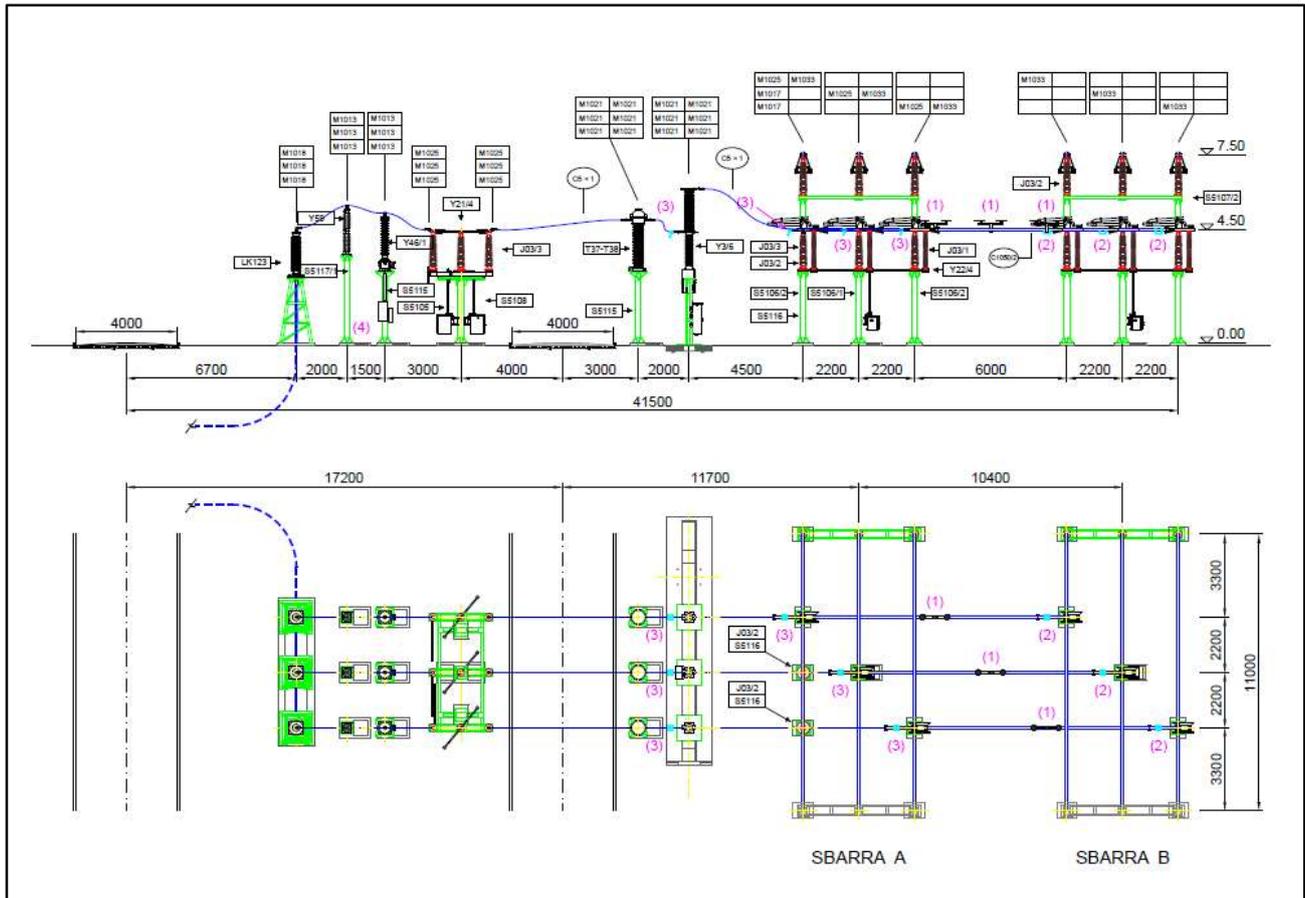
Planimetria e sezione elettromeccanica relativa alle apparecchiature dello stallo 150 kV nella stazione Terna
